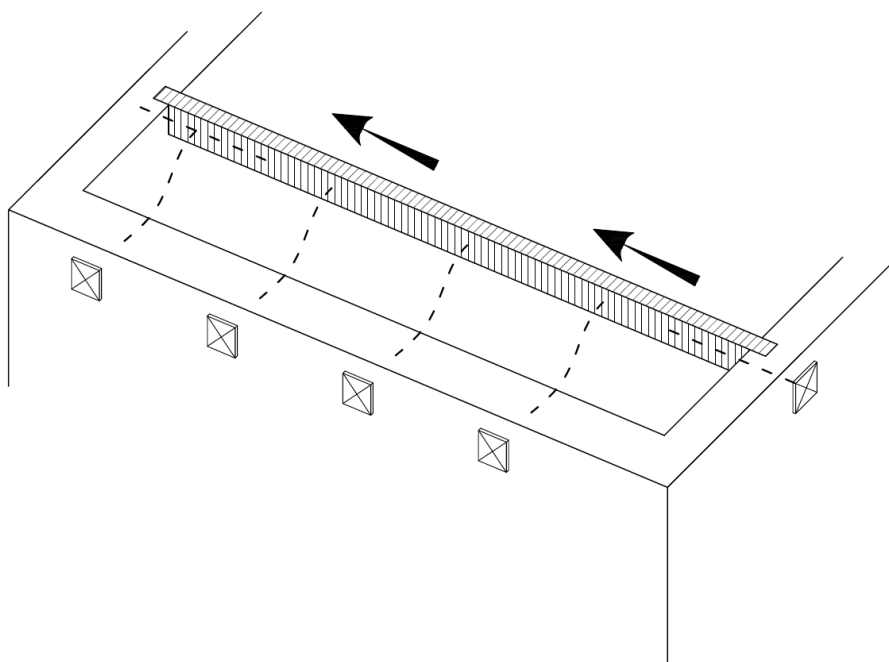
Applicazione di tirante e capochiave alla trave.
